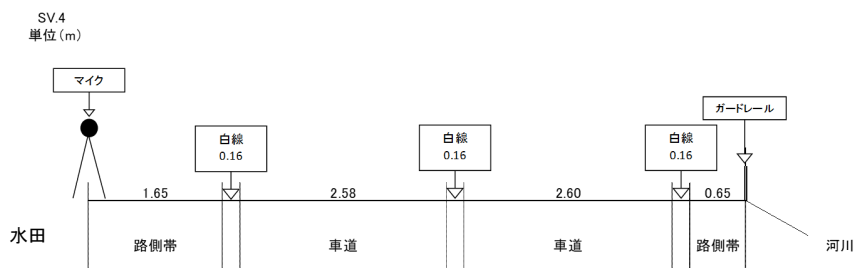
(2) 道路構造断面図 (SV.4)
